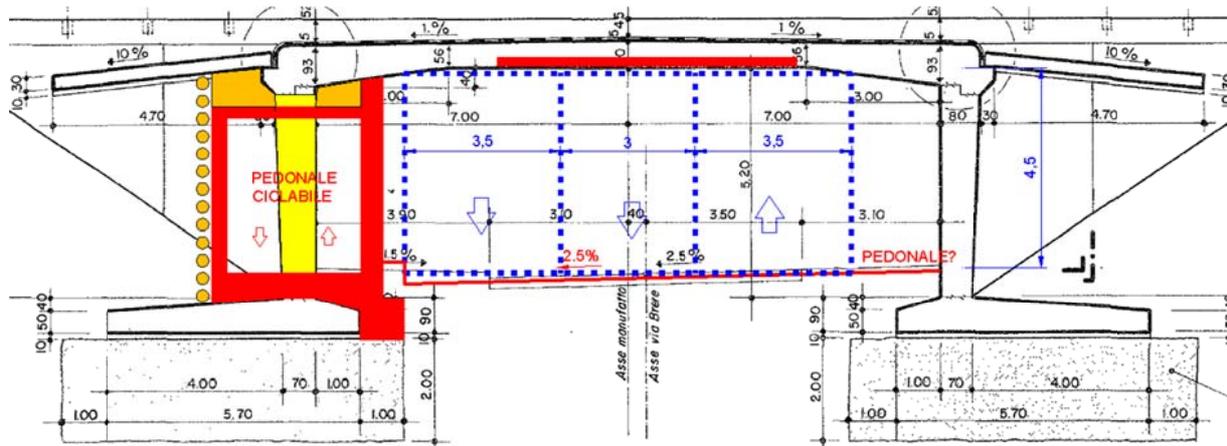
Sezione trasversale sottopasso di via Brere – Variante 1
